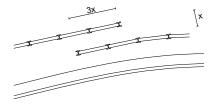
SOLAPE MÍNIMO EN APERTURAS
